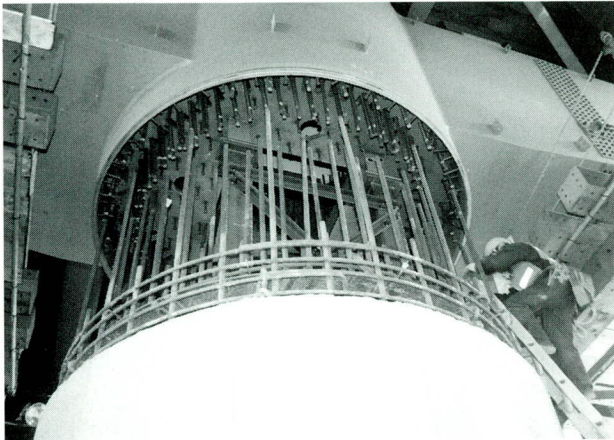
RC柱と鋼製梁の接合部チドリ継手配筋
